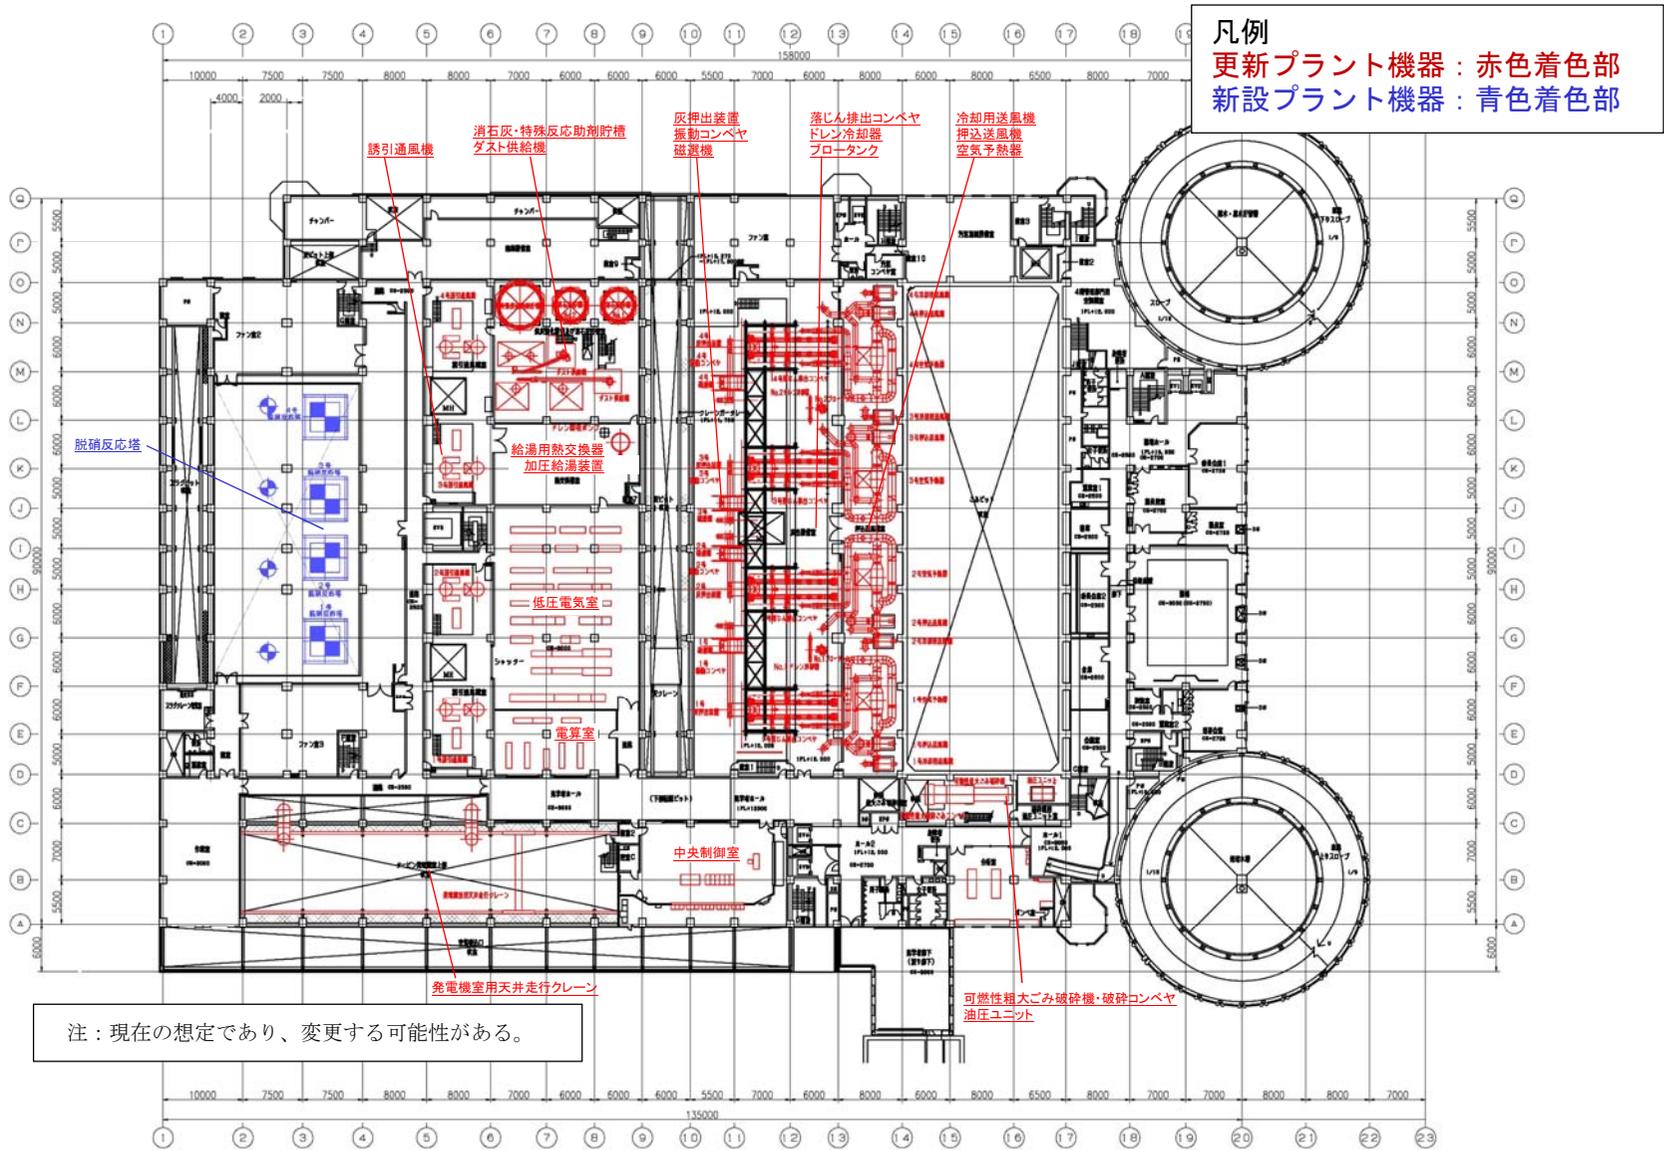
(4) 設備機器の更新箇所 (4階平面図)
